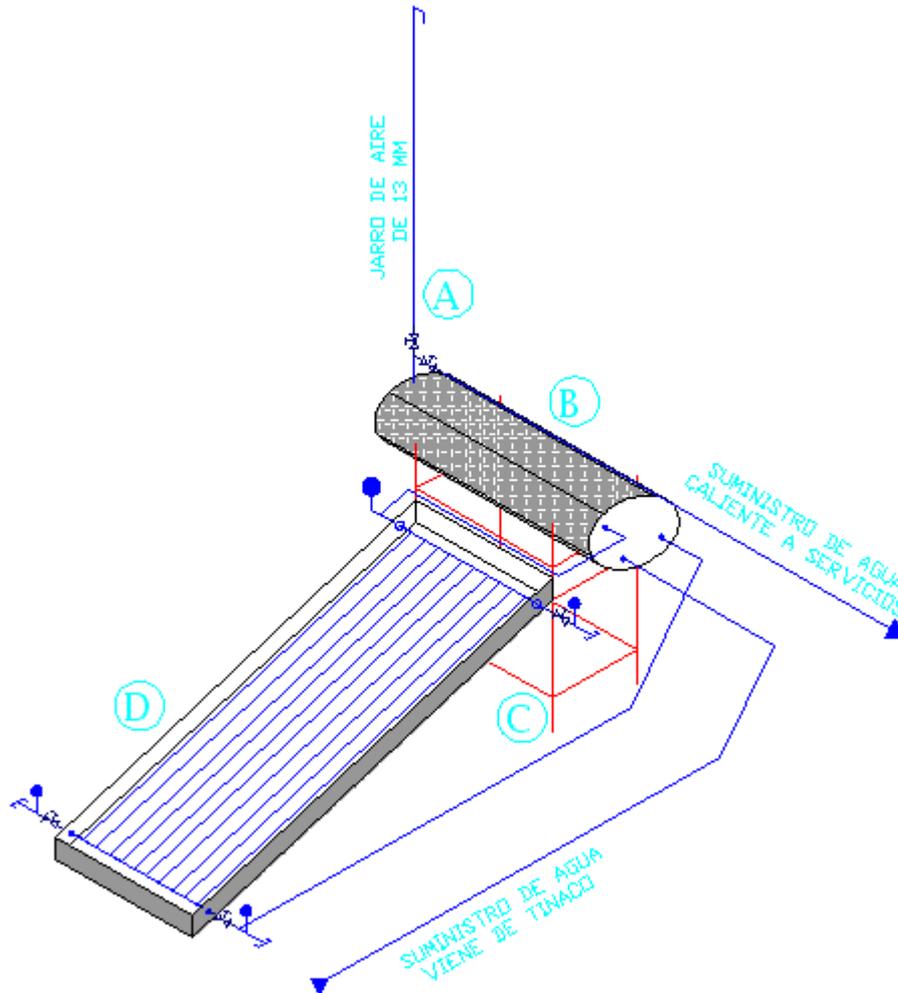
COMPONENTES DEL CALENTADOR SOLAR
